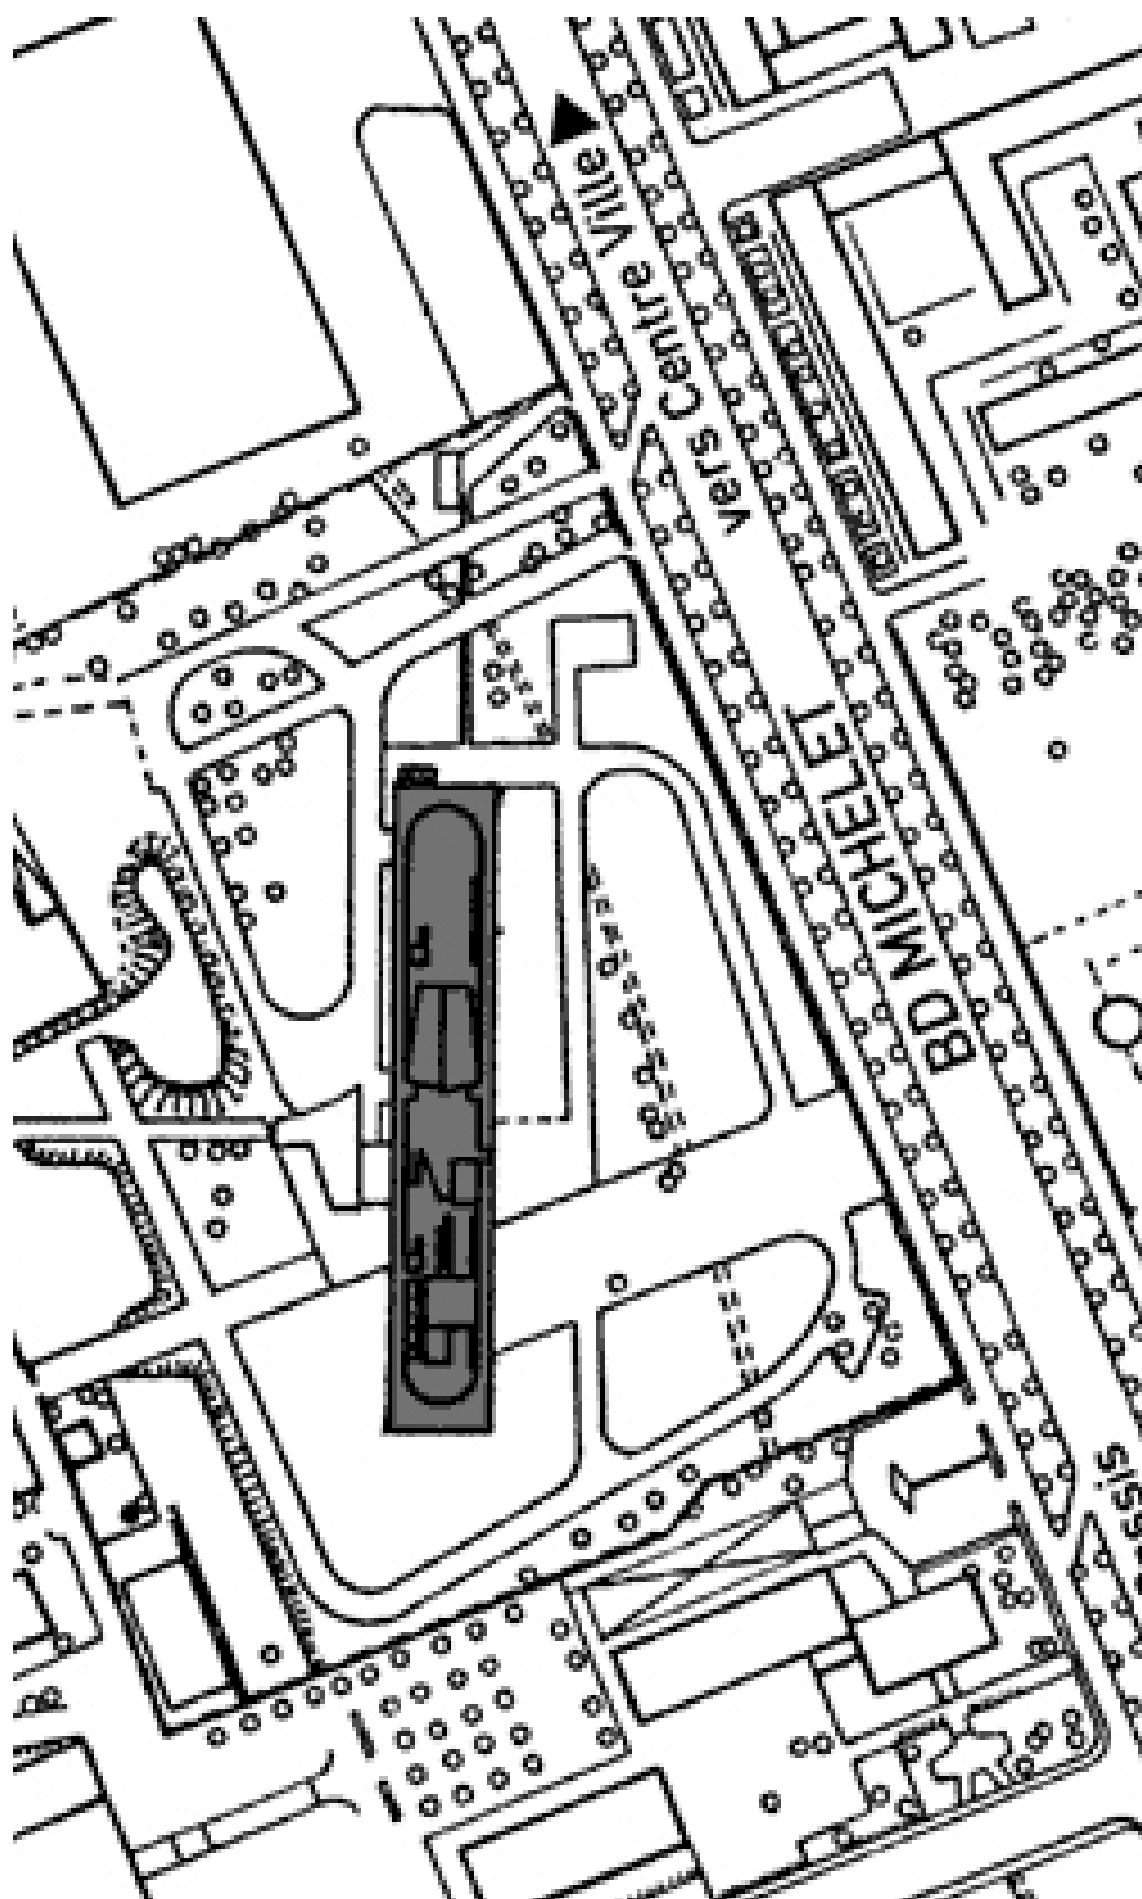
Planta de Implantação da Unidade de Habitação de Marselha
